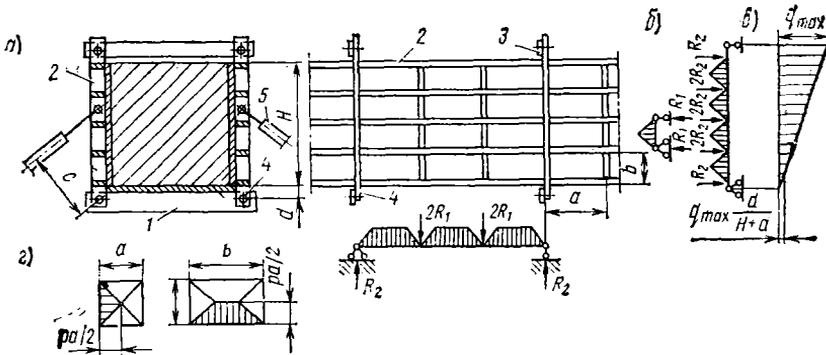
Схемы к расчету стальных опалубочных форм:
